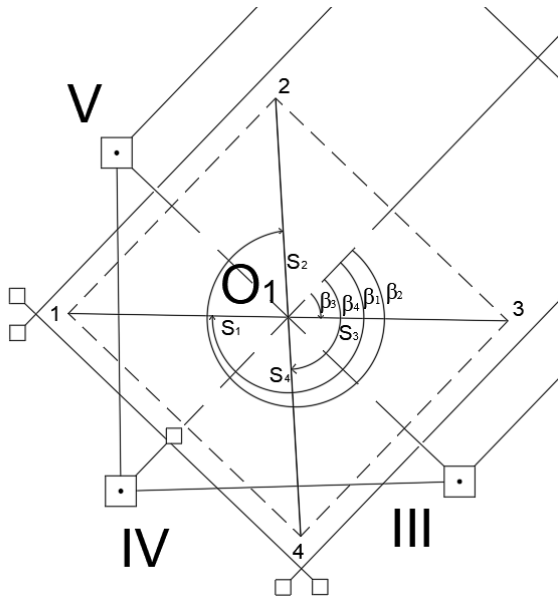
Схема розмічування монолітного фундаменту під будівлю №1
